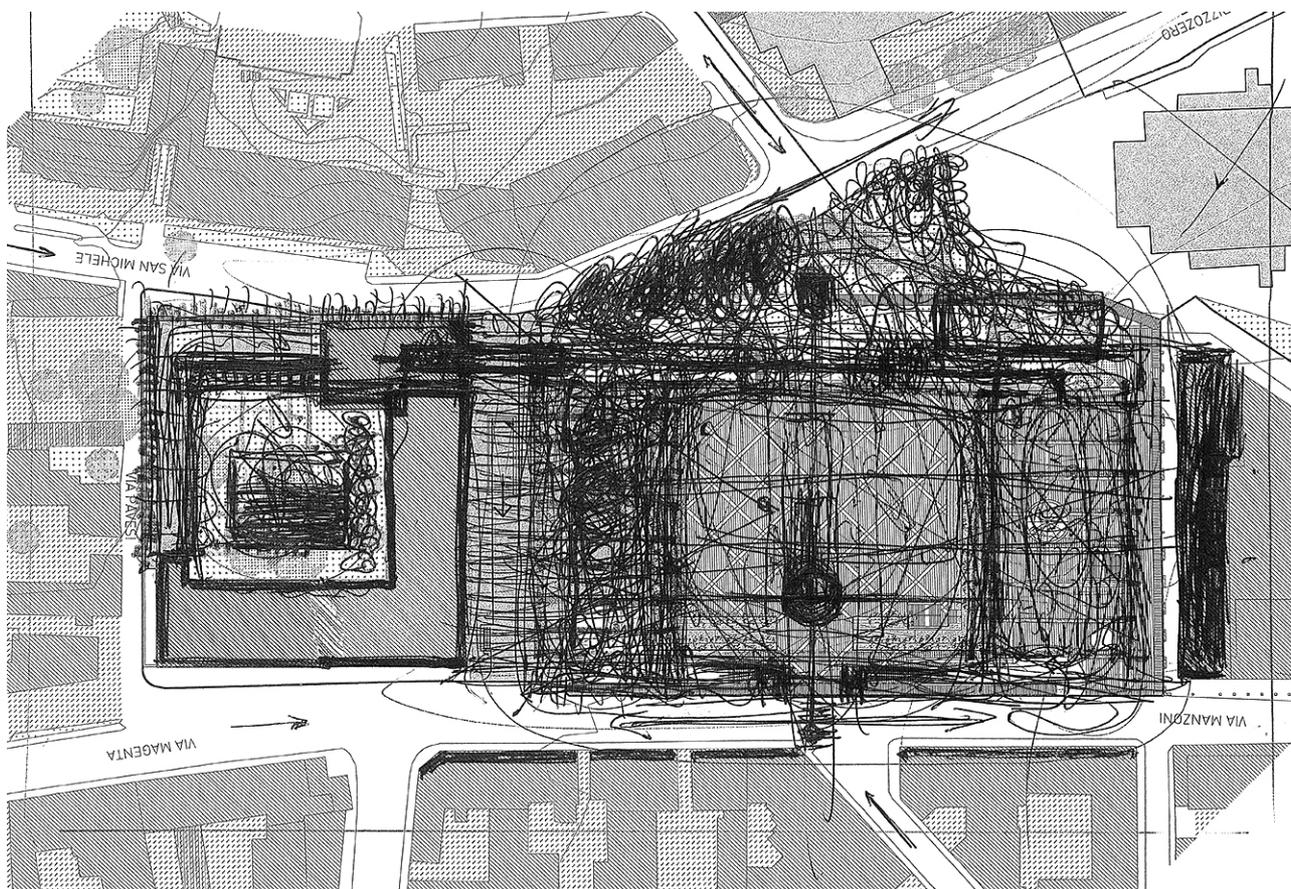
Schizzo di progetto con primi elementi di individuazione delle funzioni proposte
